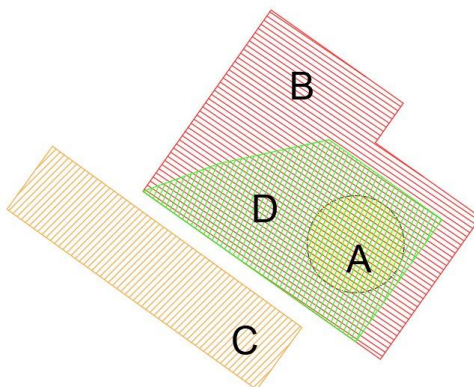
Planimetria "tipo" delle aree di servizio (piazzola)
